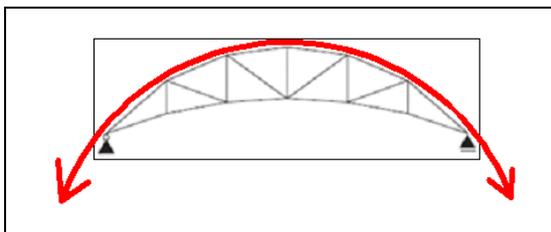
le schéma statique de la poutre utilisée avec la tension appliquée.
